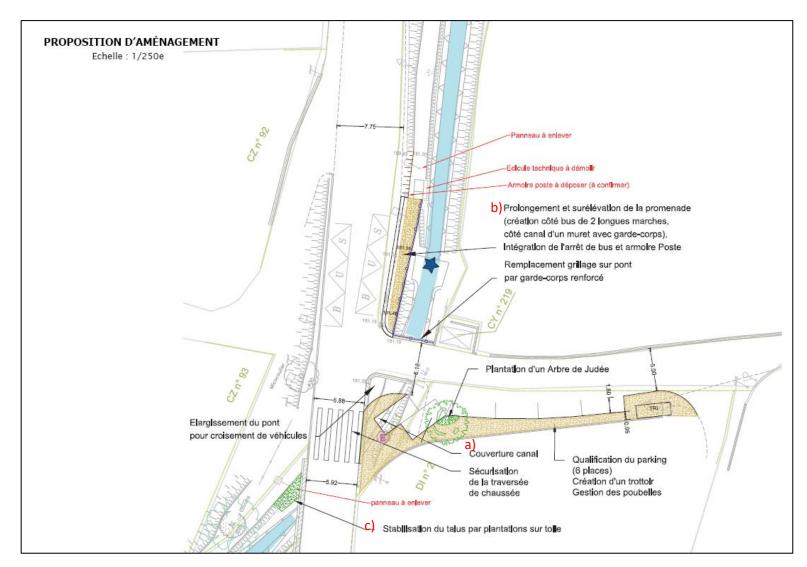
Plan des aménagements proposés pour la traversée RD4
